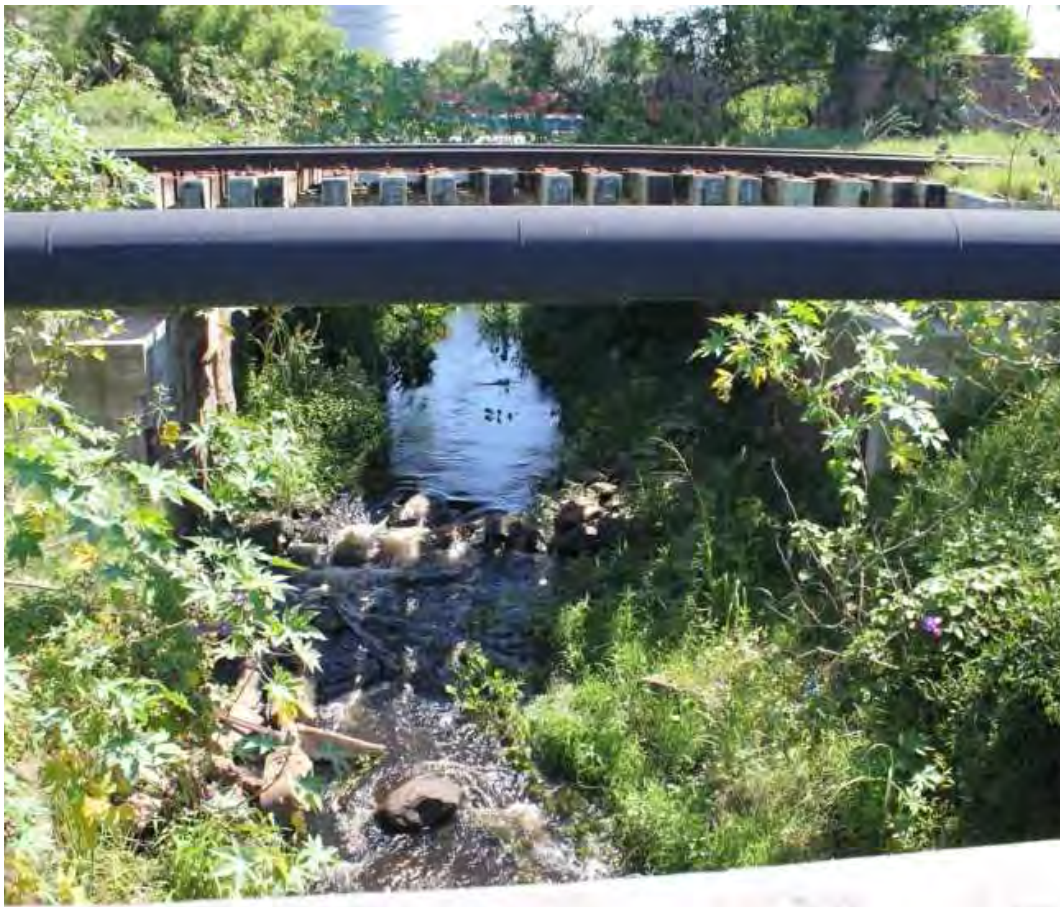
Seção retangular de passagem do arroio das Cabeças sob a estrada de ferro
